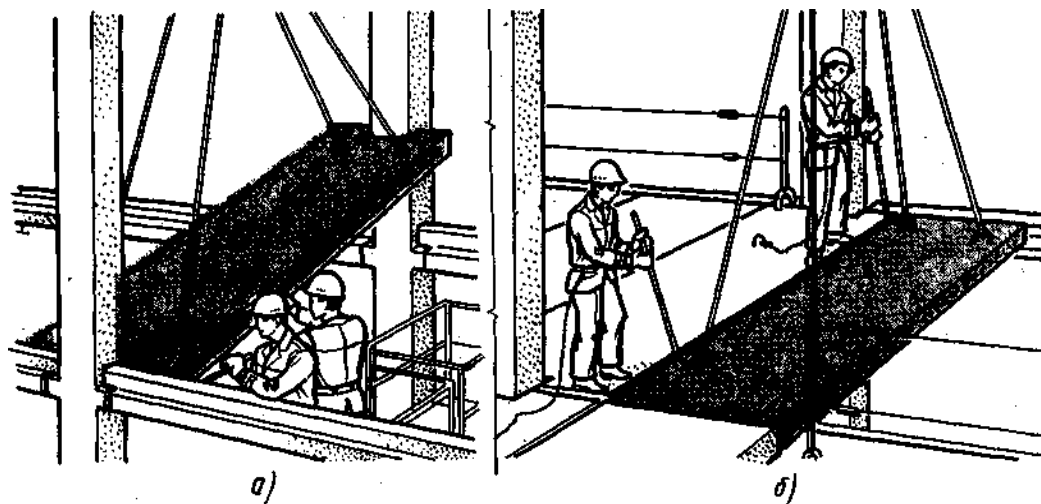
Укладка связевой (распорной) (а) и рядовой (б) плит перекрытия
